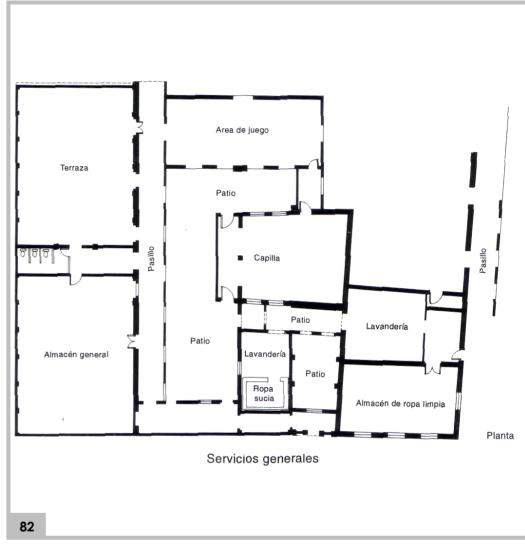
Planta baja, planta alta y fachada zona de encamados. IMAGEN 82 Planta de servicios generales.
